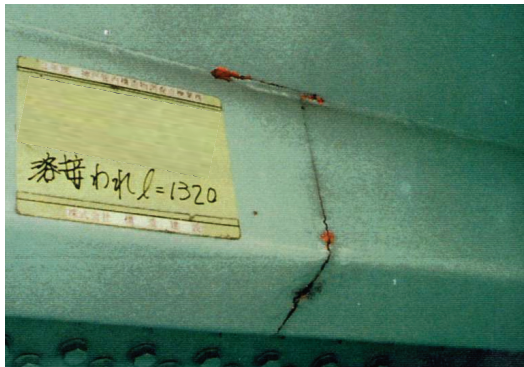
Uリブ突き合わせ溶接部のき裂
